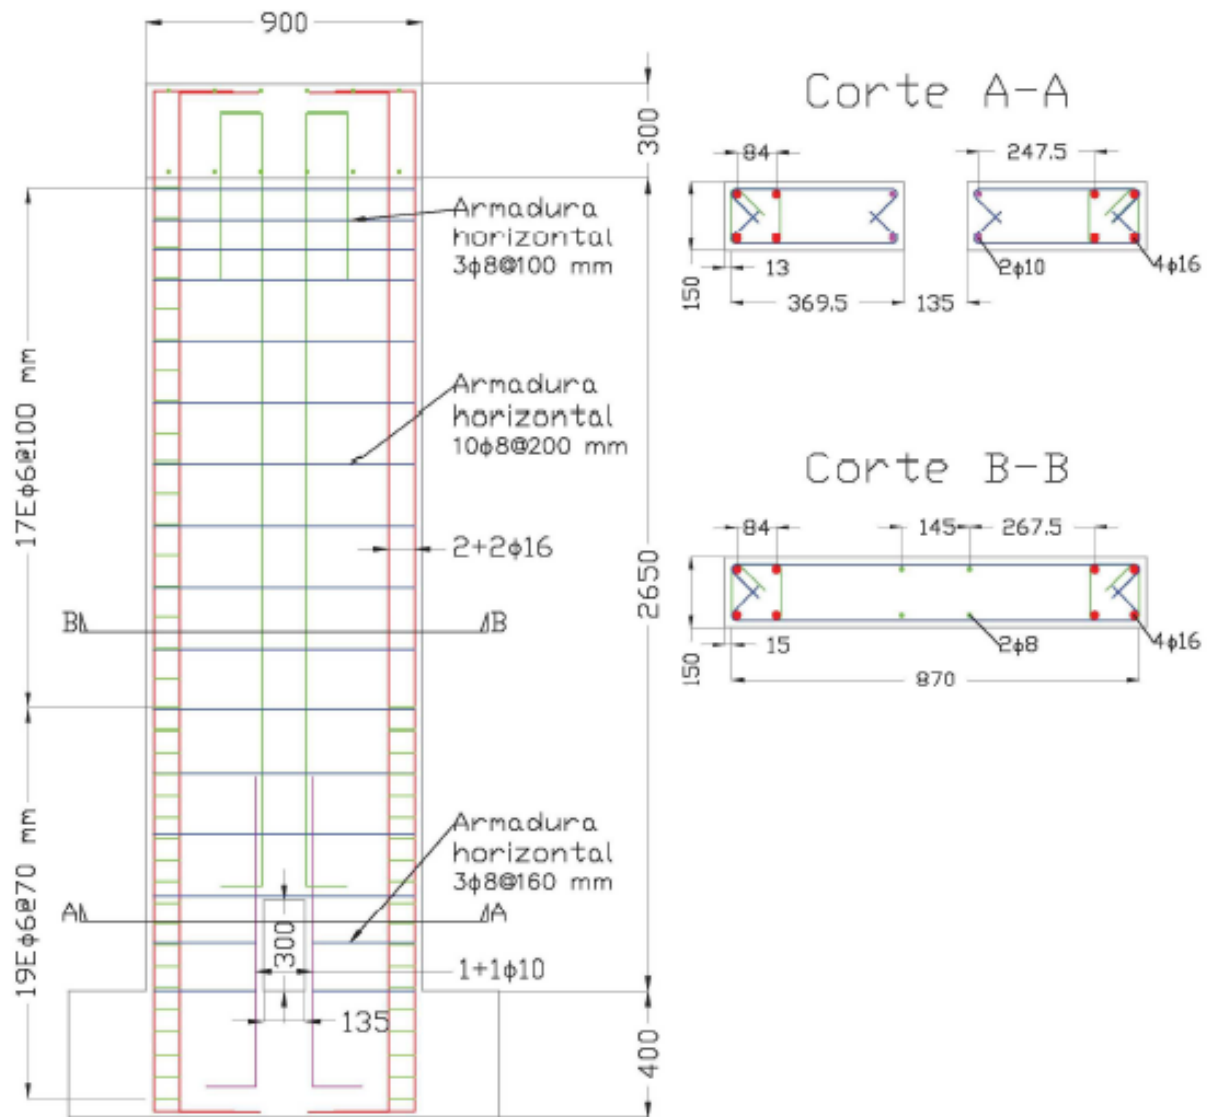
Detallamiento de la armadura de la probeta 1 de muro con abertura.
